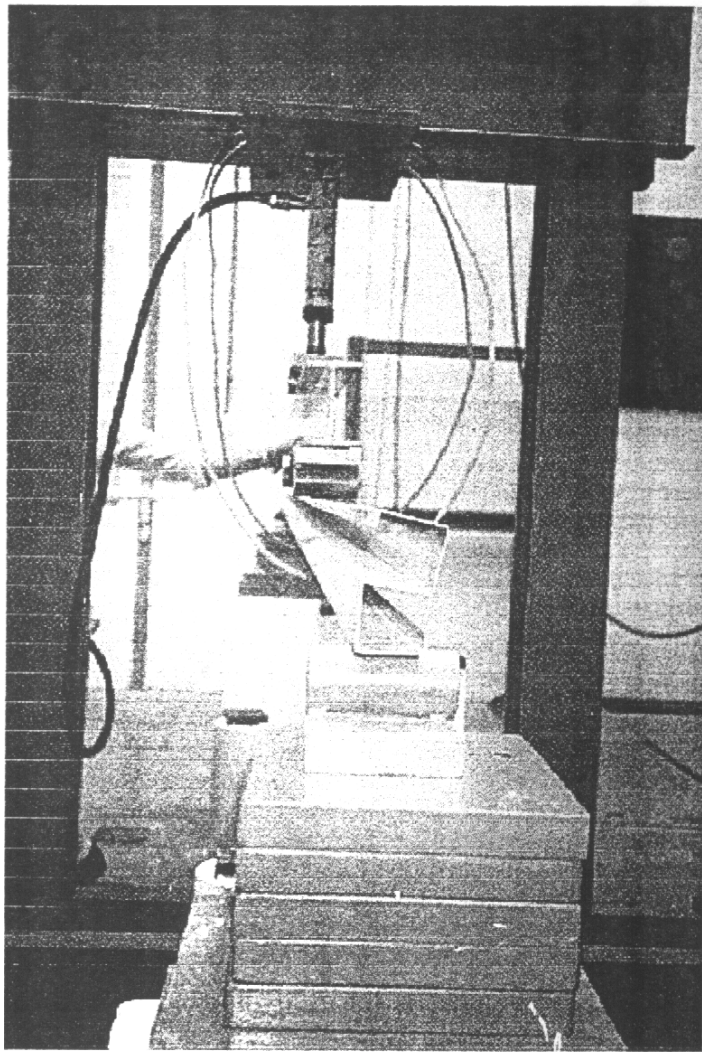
Deformada do perfil M4AZ ensaiado na posição vertical.
